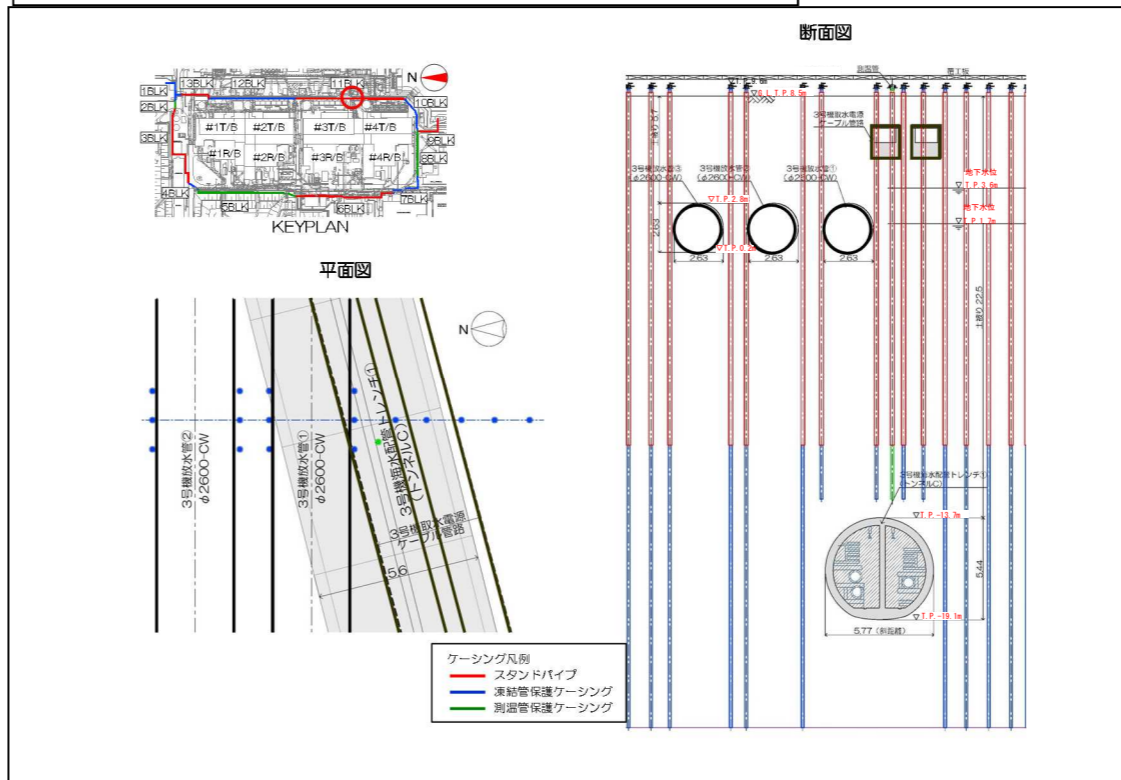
3号機海水配管トレンチトンネルC部 施工平面図・断面図
